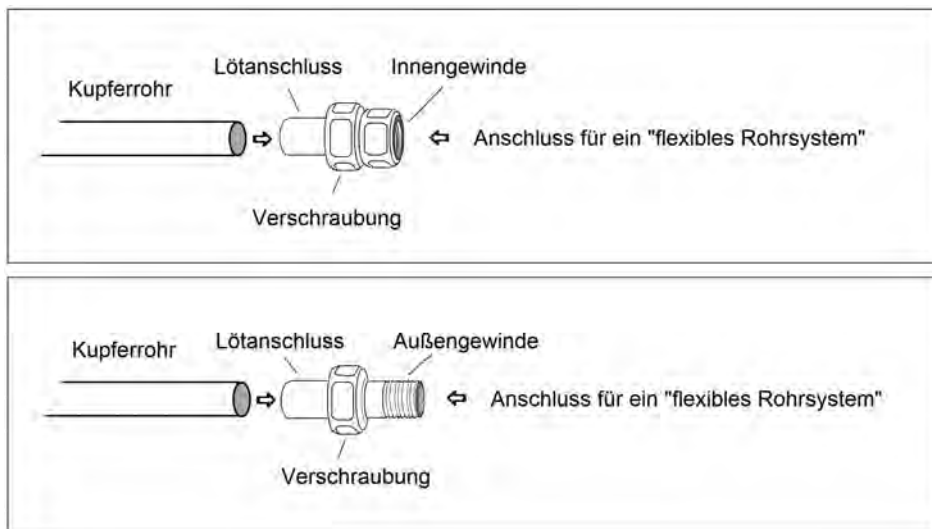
oben: Konisch dichtende Löt-/Schraubverbindung mit einem Innengewinde; unten: Konisch dichtende Löt-/Schraubverbindung mit einem Außengewinde
